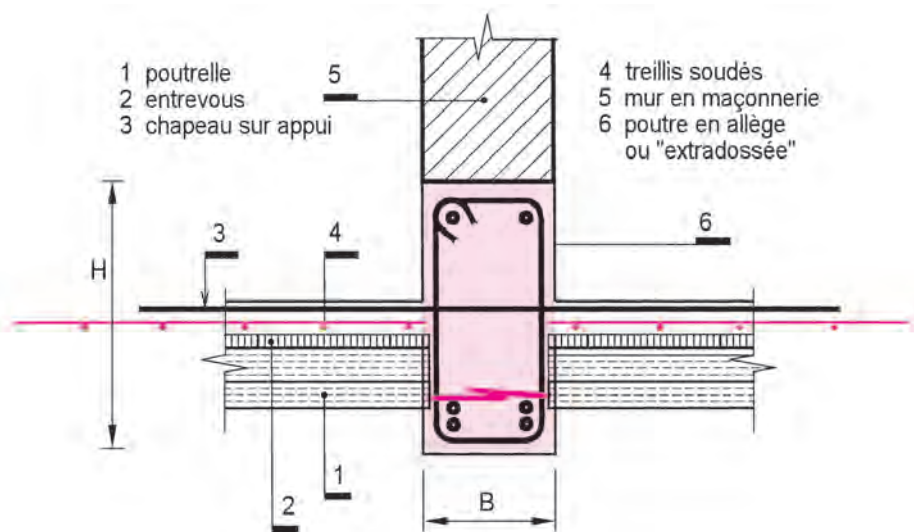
Coupe sur poutre avec petite retombée sous plancher pour permettre l'appui des poutres précontraintes
